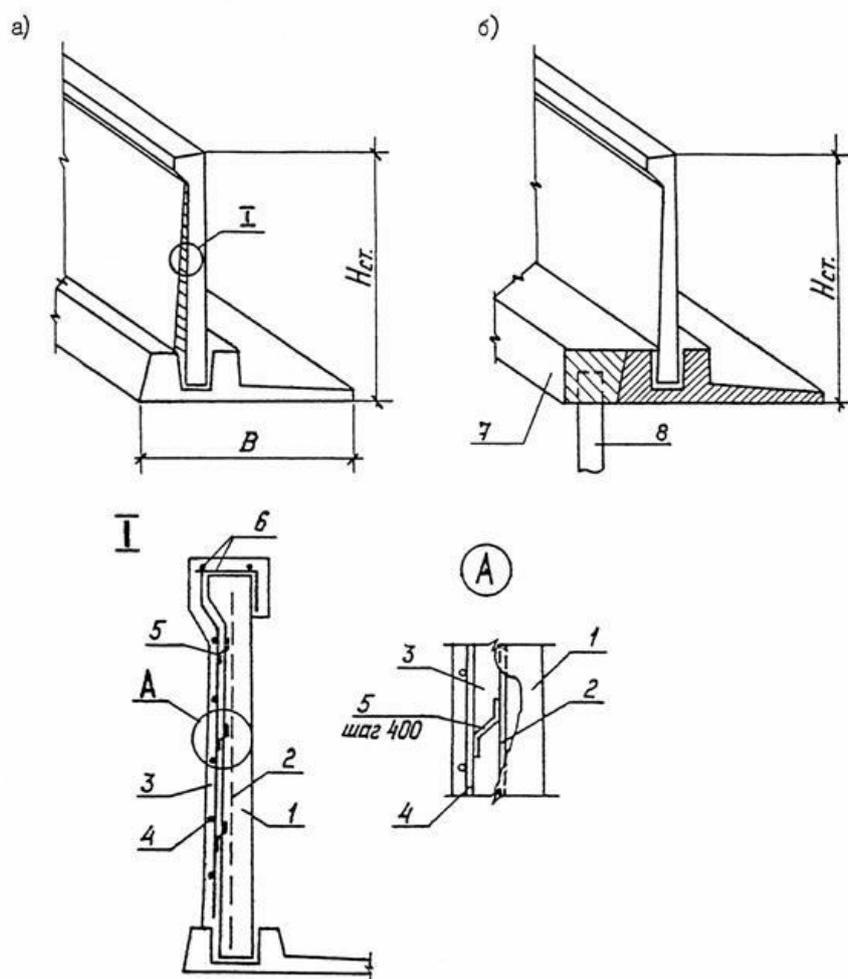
Усиление железобетонной подпорной стены: 1 – усиливаемая конструкция; 2 – арматура усиливаемой конструкции; 3 – бетон усиления класса В15; 4 – дополнительная горизонтальная и вертикальная арматура; 5 – коротыши из круглой стали. Приварить по ГОСТ 140-98-85; 6 – арматура наращиваемого верхнего пояса; 7 – монолитный бетонный ростверк; 8 – упоры (в виде забивных железобетонных свай, свай или стального шпунта)
